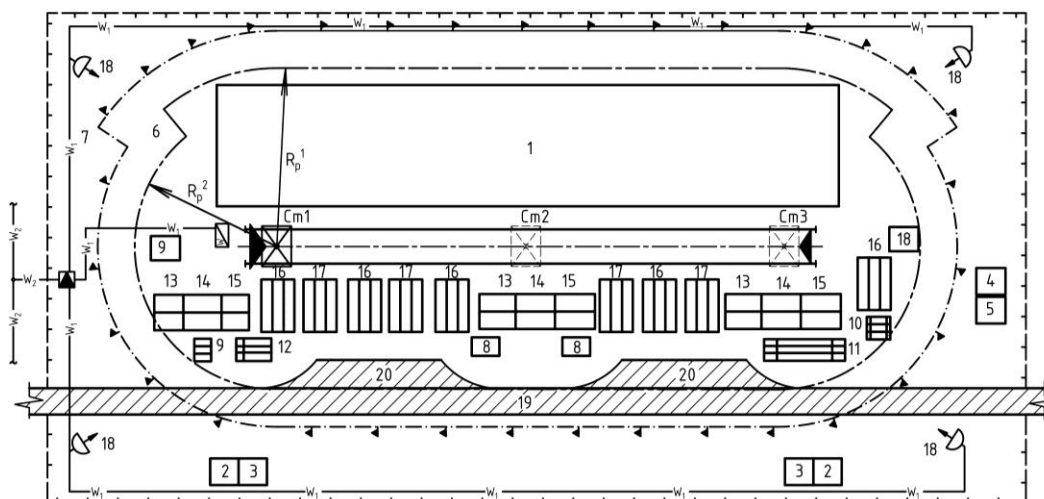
Организация строительной площадки: 1 – строящееся здание; 2 – навес для сантехнических материалов и заготовок; 3 – навес для столярных изделий; 4 – склад для инвентаря и инструмента; 5 – мастерская для специальных работ со складом; 6 – зона крана; 7 – граница опасной зоны; 8 – площадка для приема раствора; 9 – открытая площадка для складирования отдельных элементов; 10–17 – склады сборных элементов; 18 – прожекторы; 19 – автодорога; 20 – разгрузочная площадка.
